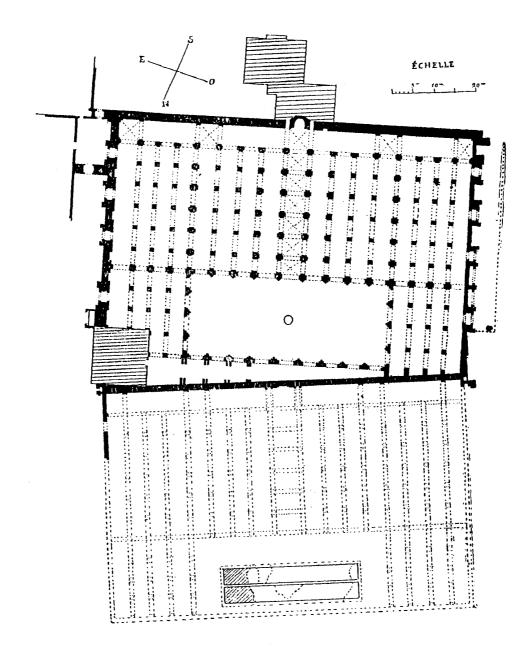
مسقط أفقي لجامع القرويين بفاس (المغرب الأقصي) . (عن : هوج) .
